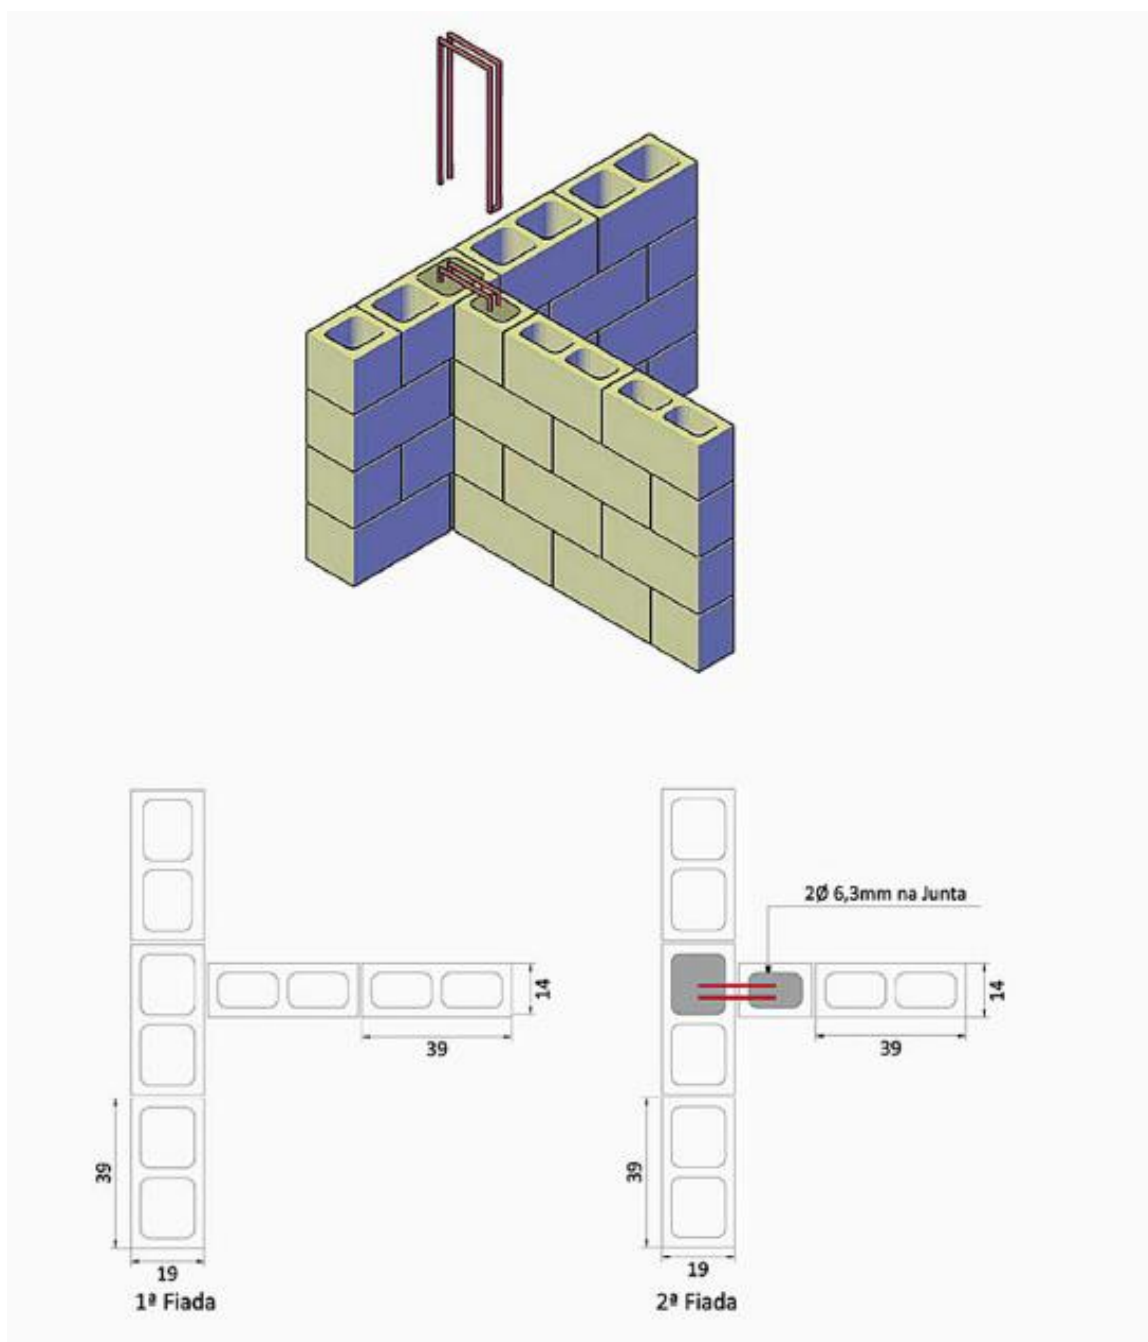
Colocação de grampo para travamento. Fonte: Tauil; Nese (2010).
